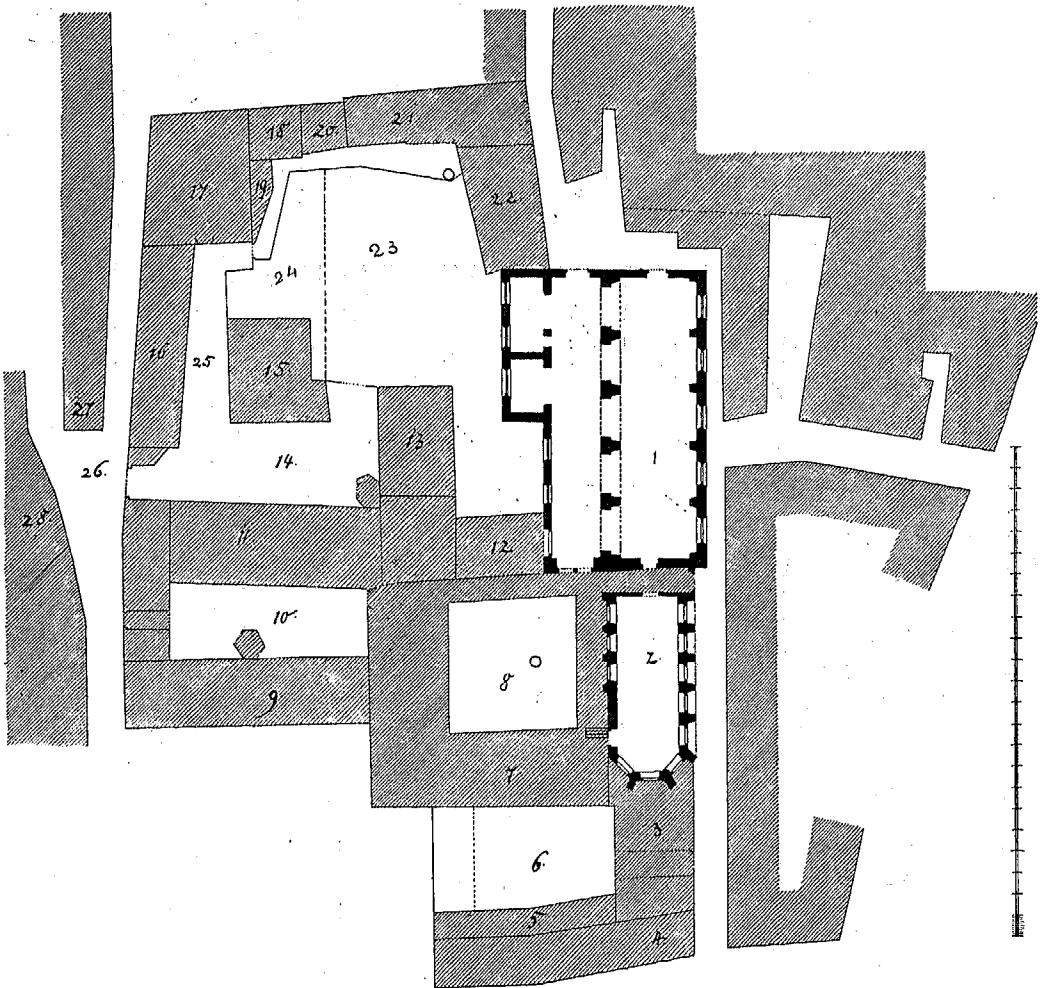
Ehemalige Barfüsser-Kirche; Lageplan.
